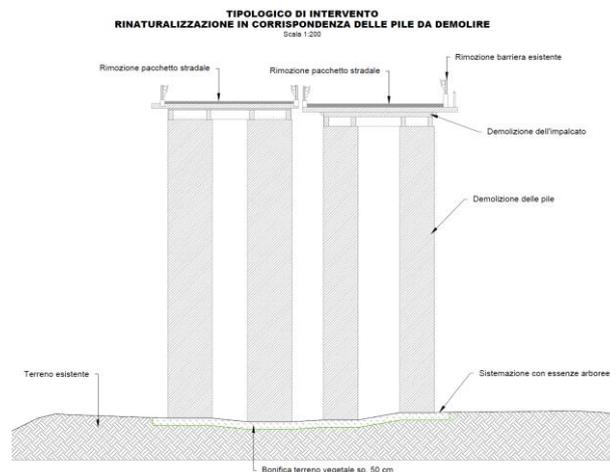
Sezione tipo rinaturalizzazione in corrispondenza delle pile da demolire
